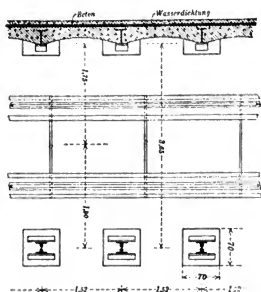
Grundriss des viergleisigen Tunnels.
